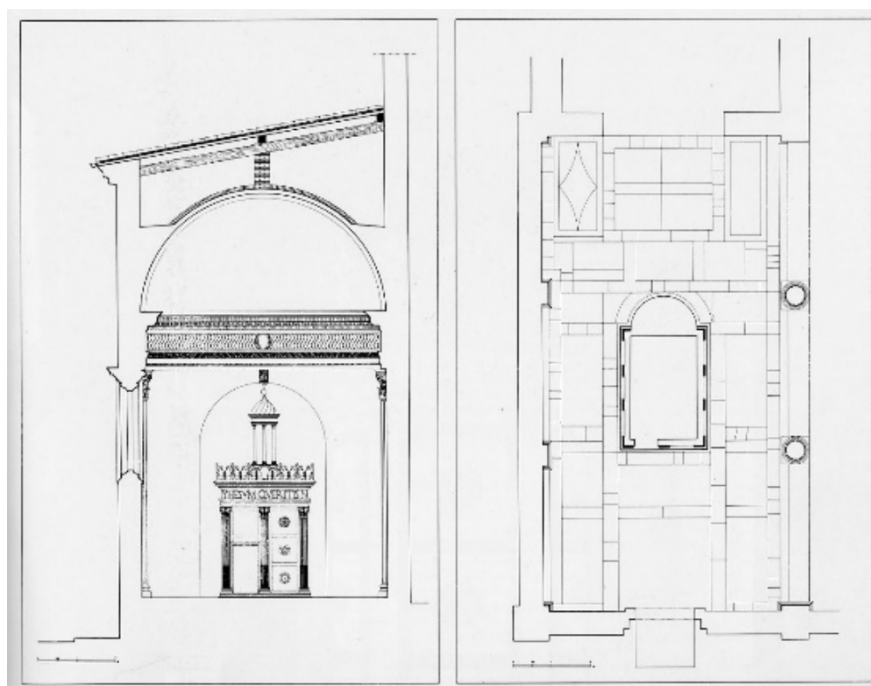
Leon Battista Alberti, Cappella Rucellai (pianta e sezione)
